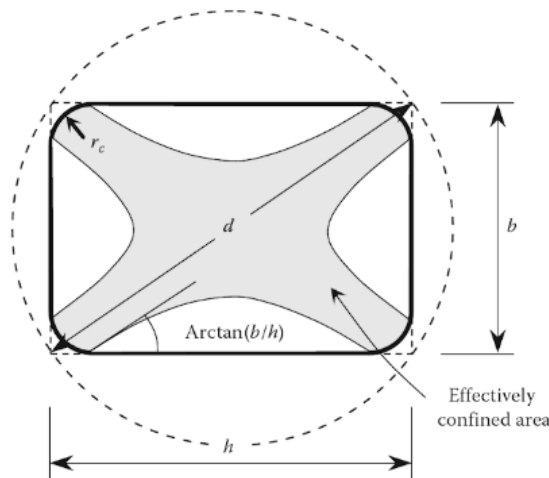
Área da seção de concreto efetivamente confinada (HOLLAWAY, L.C e TENG J.G *apud* LANG e HERWING, 2013).
